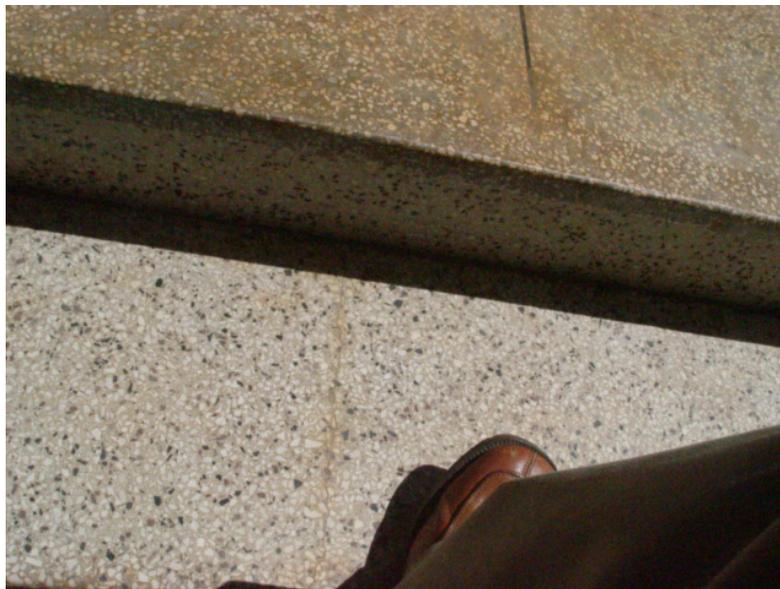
y N° 24. Obra III. Deficiente ejecución de escalera. Desprendimiento de contrapiso y de planchas de granito reconstituido.
